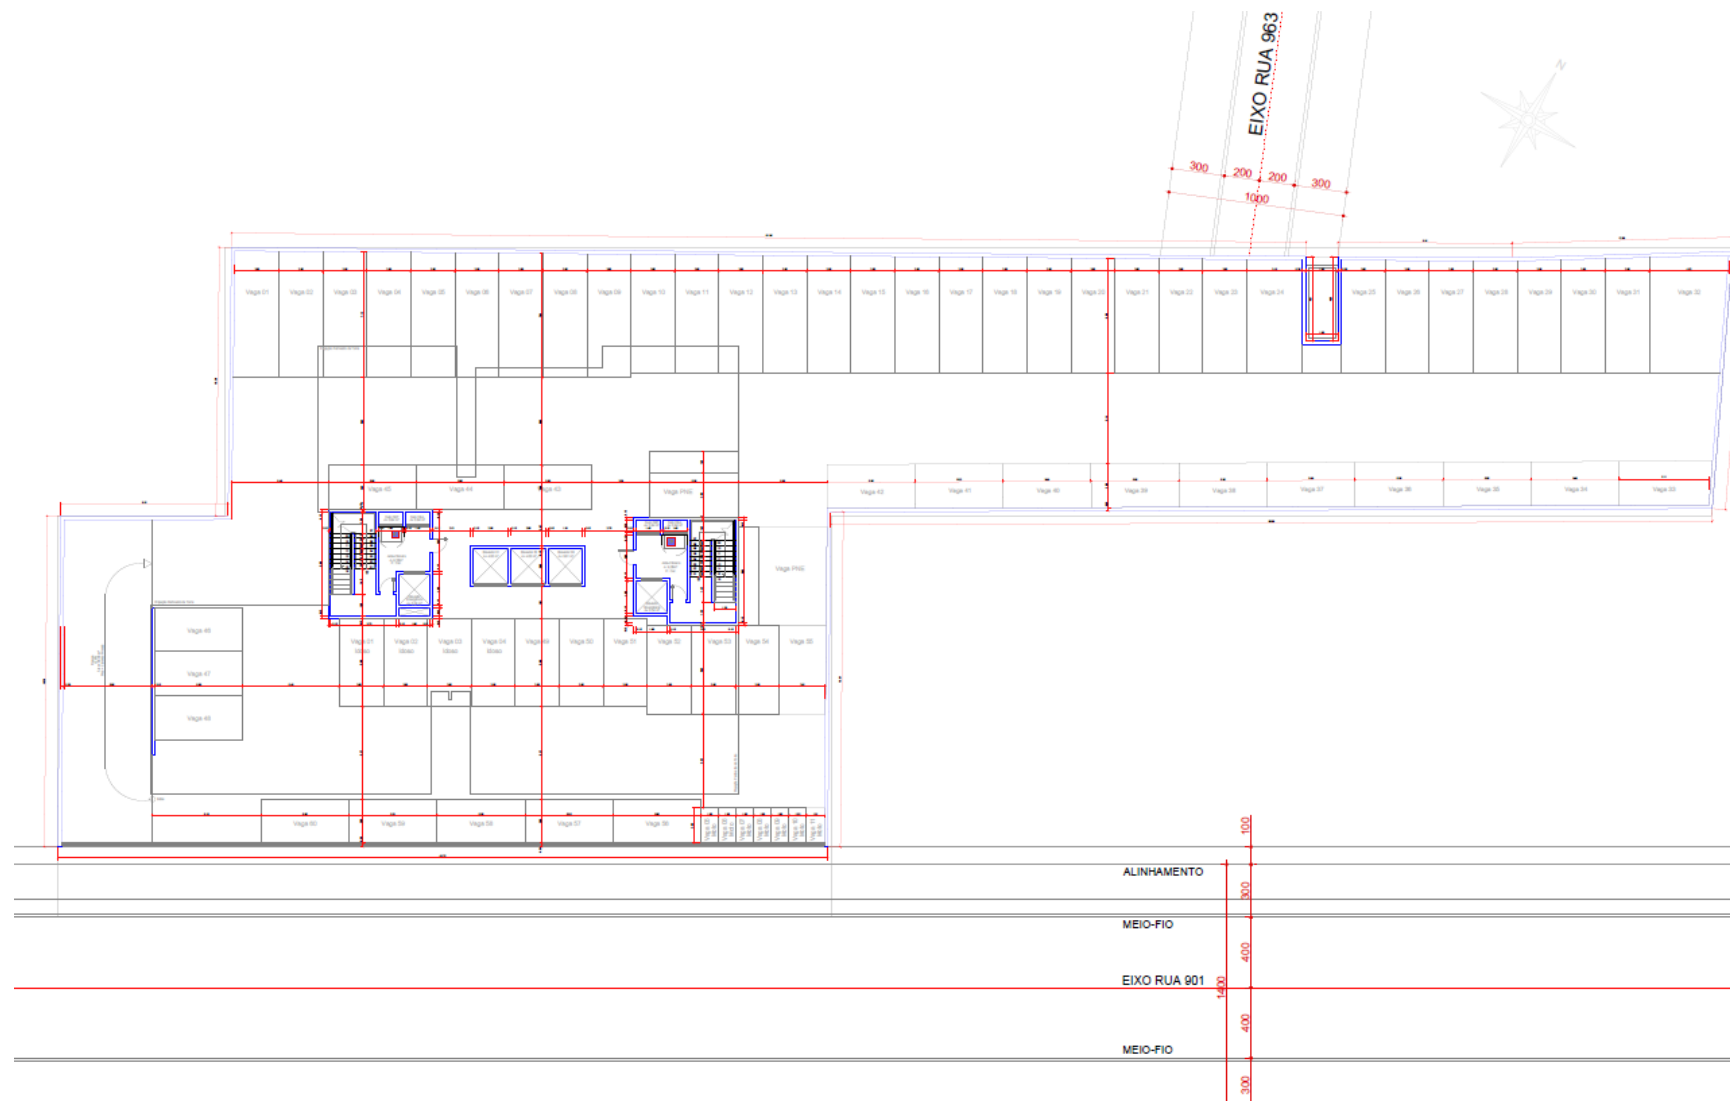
Planta Baixa - 2º Pavimento Garagem - Área: 2.063,10m².
